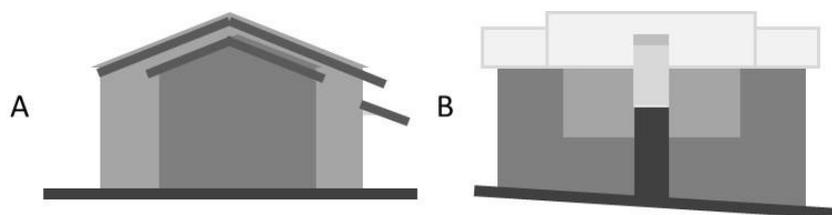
Fachadas: A - Fachada lateral do bloco residencial; B - Fachada frontal.
